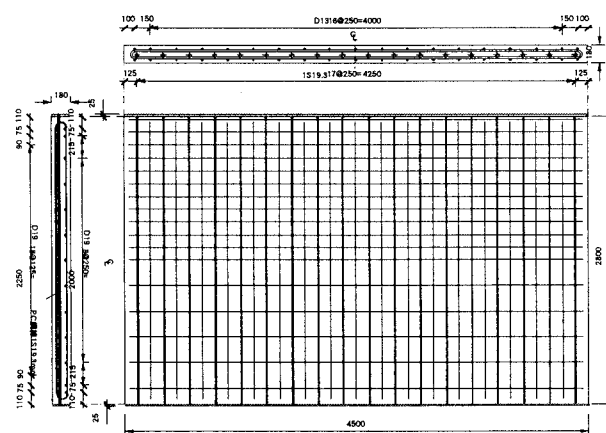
PC 8 供試体の形状・寸法 (単位: mm)
